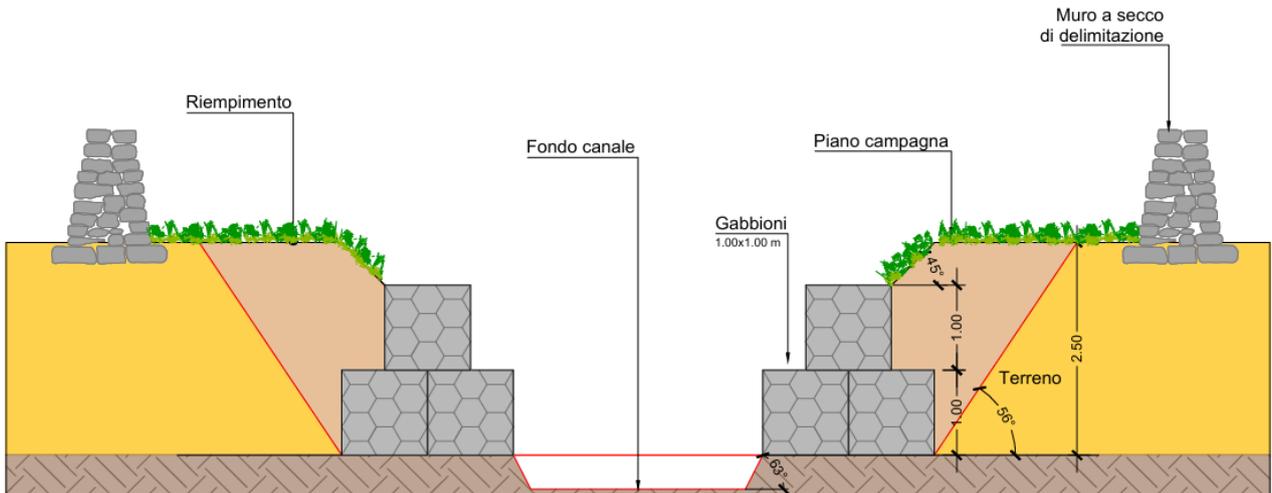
Sezione tipo del canale, delimitata da muretti a secco di nuova realizzazione
